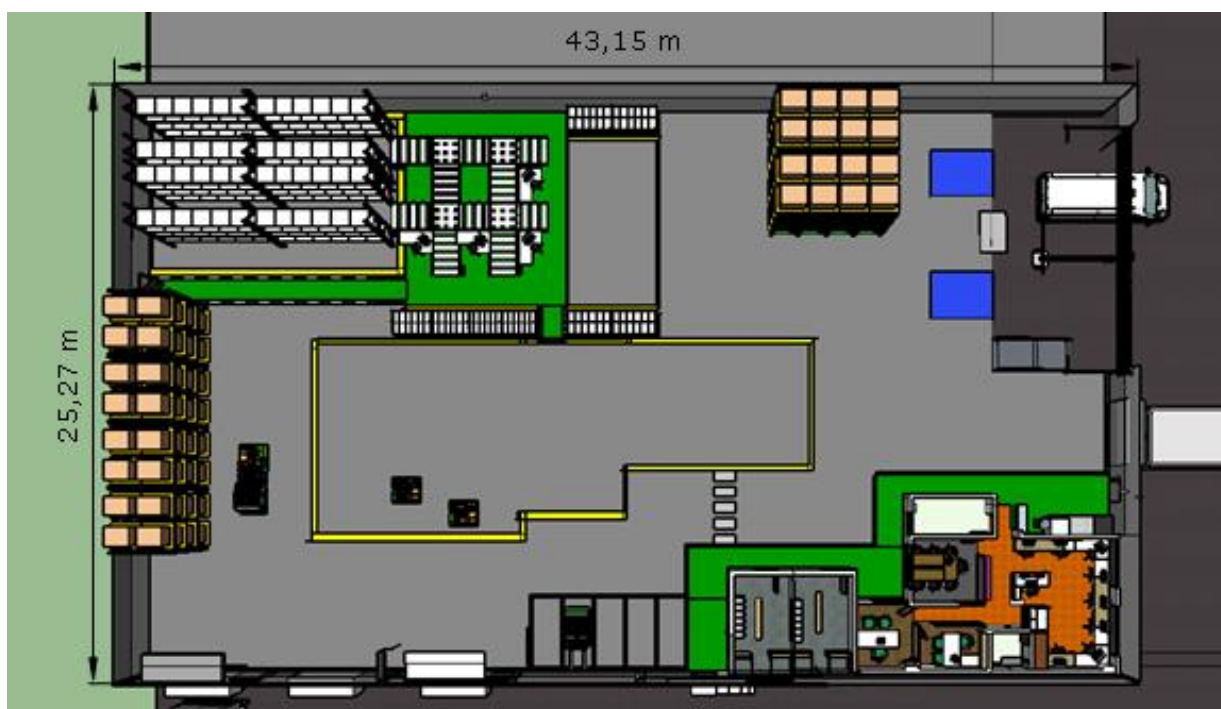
Plano y vista interior de la nave de almacenamiento.
